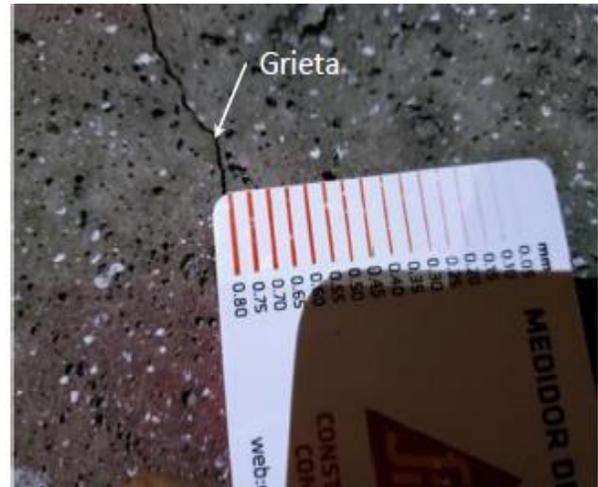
Grietas viga base Tramo 3 (4+535 A 4+547) (11-12-2018)
